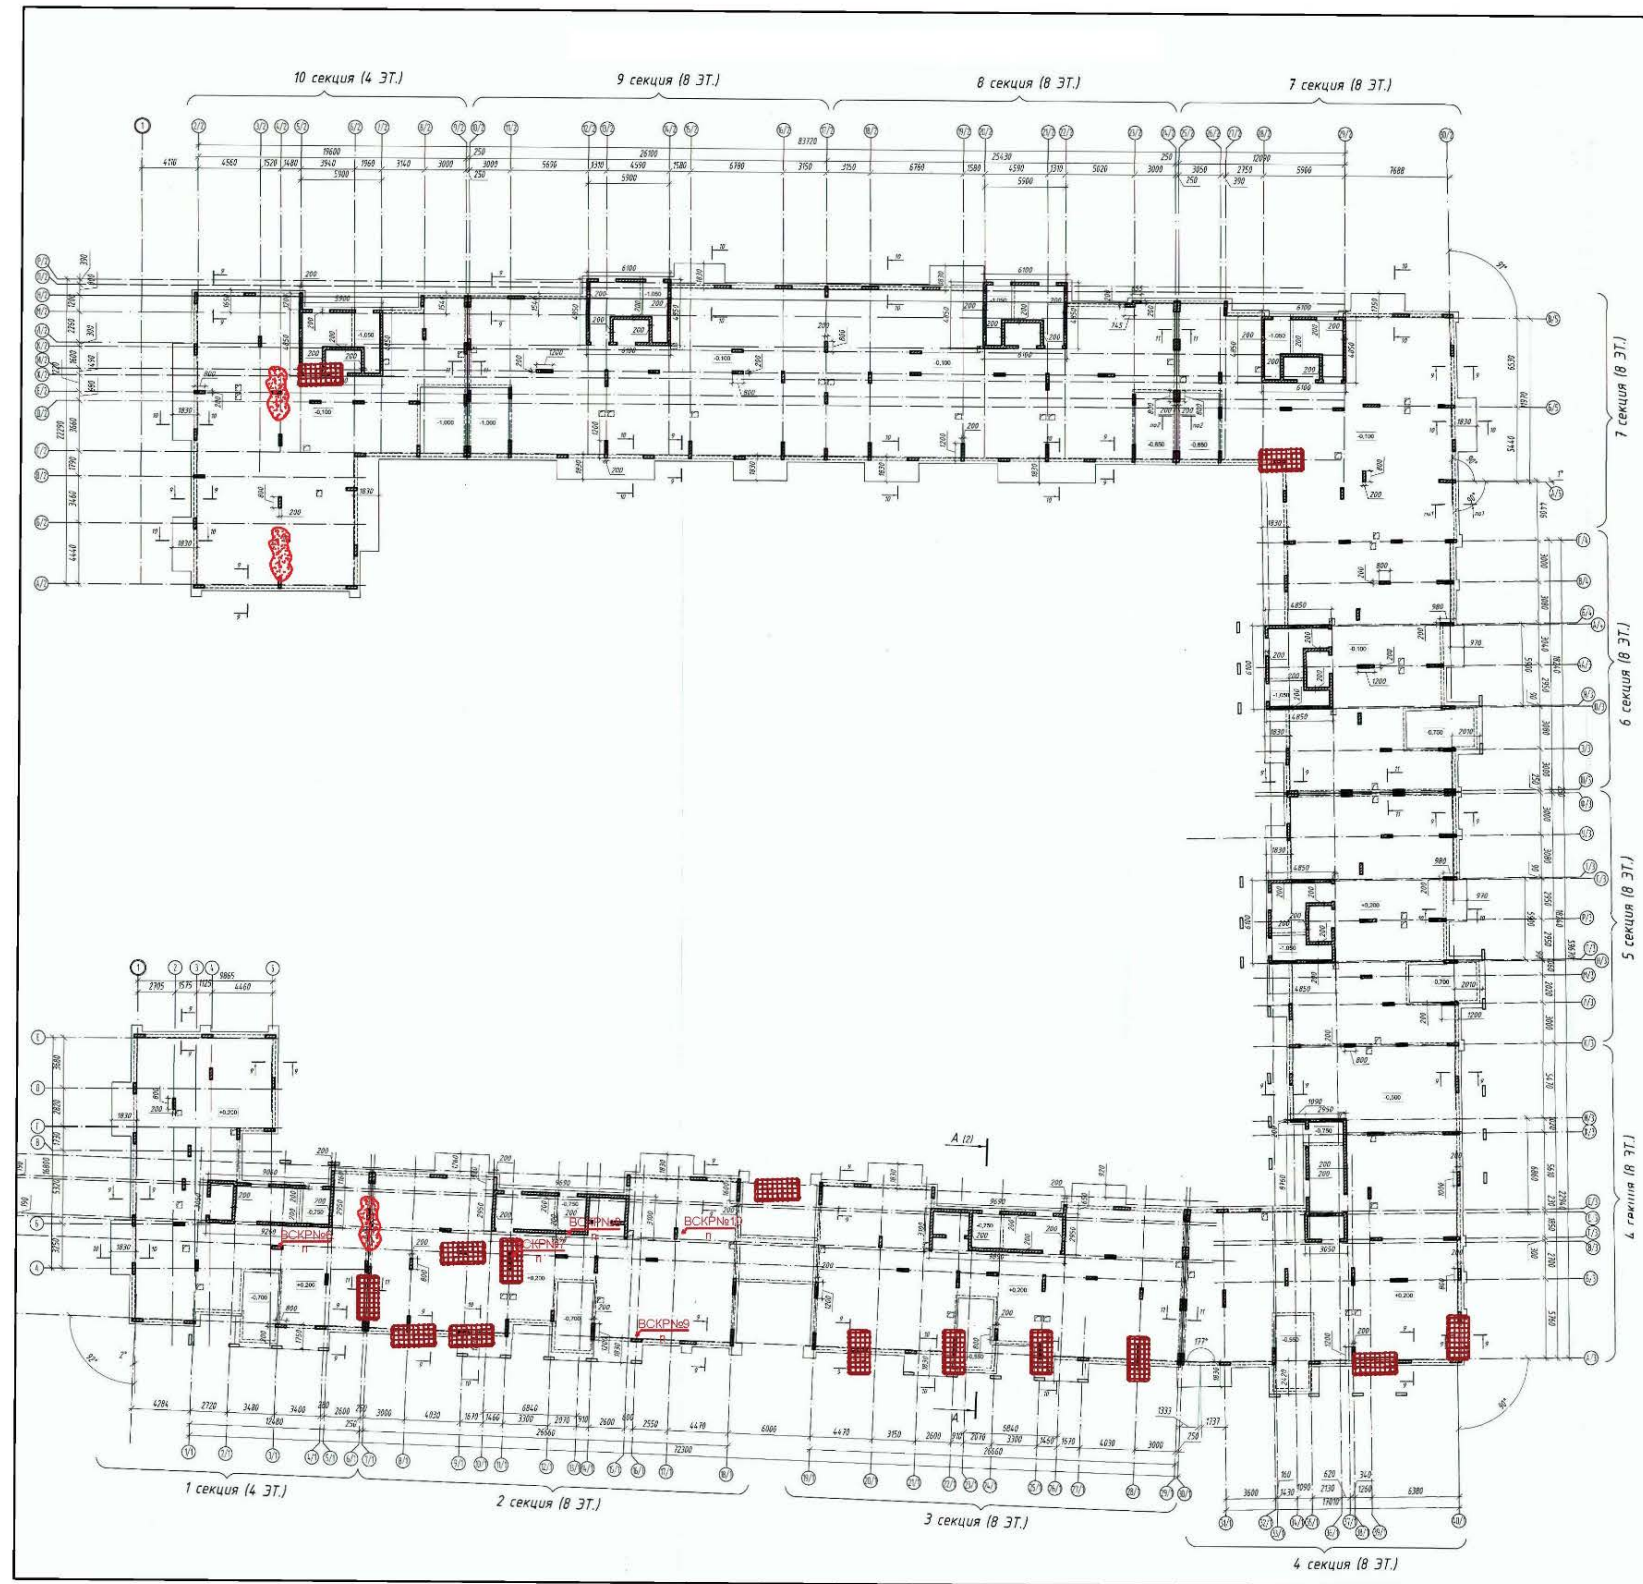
Карта дефектов верхней плоскости плиты перекрытия второго этажа вертикальных конструкций 3-го этажа
